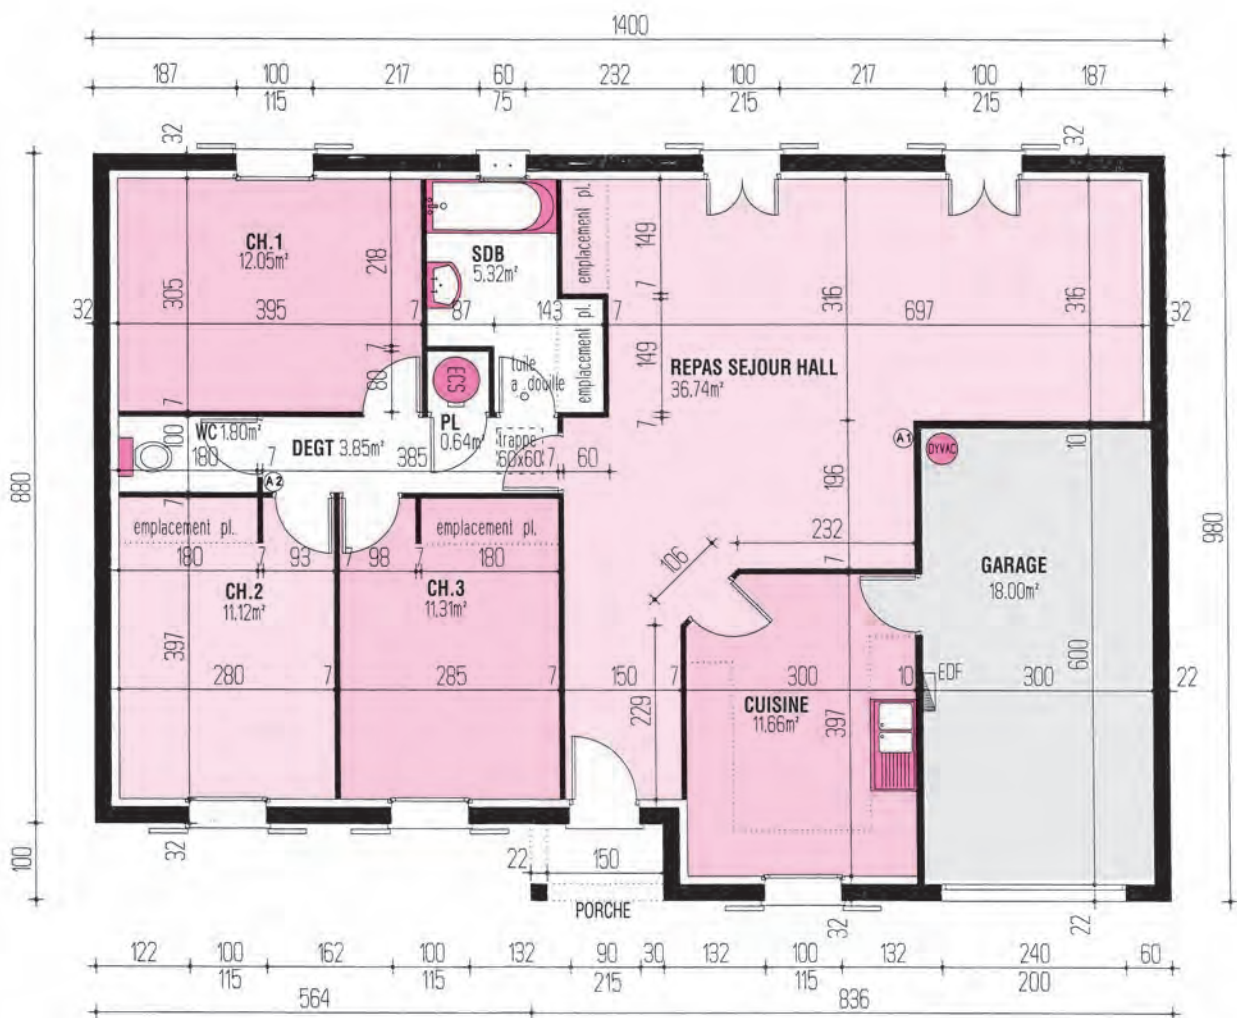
Plan du rez-de-chaussée et position des appareils sanitaires pour réaliser le réseau d'évacuation
